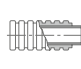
Монтажные ситуации при теплоизоляции трубопроводов
